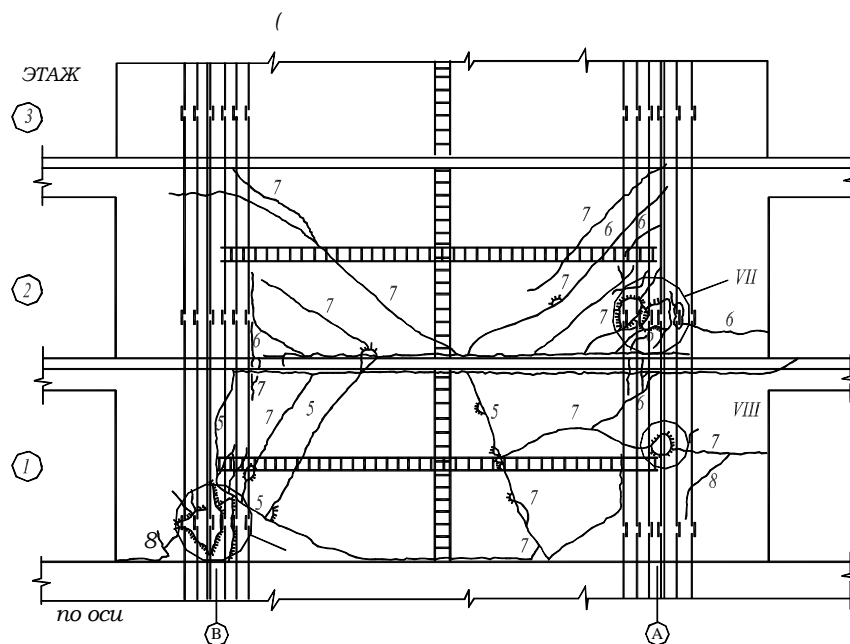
Схема трещинообразования стены фрагмента 1, армированной крестообразными каркасами (вид снаружи).
